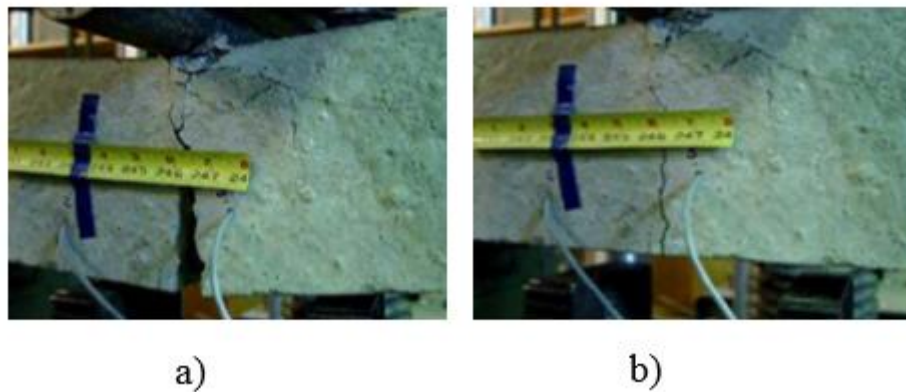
Poutre contenant des fils en AMF. a) ouverture de fissures provoquée par chargement mécanique, b) fermeture de fissures grâce à auto-restauration.
